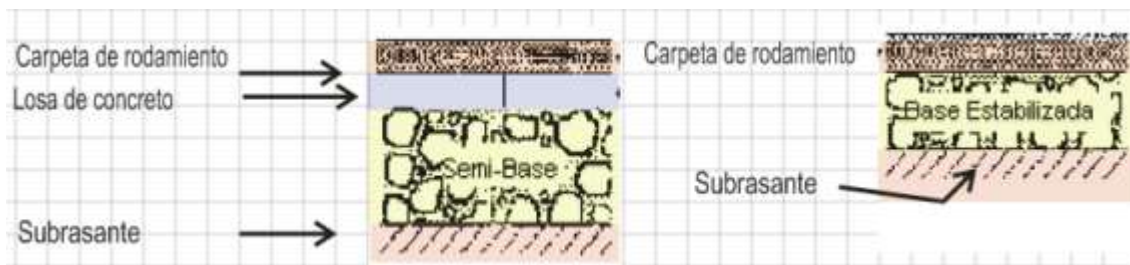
Sección de pavimento semi rígido. (Fuente: Manual para la revisión de diseño de pavimentos)
